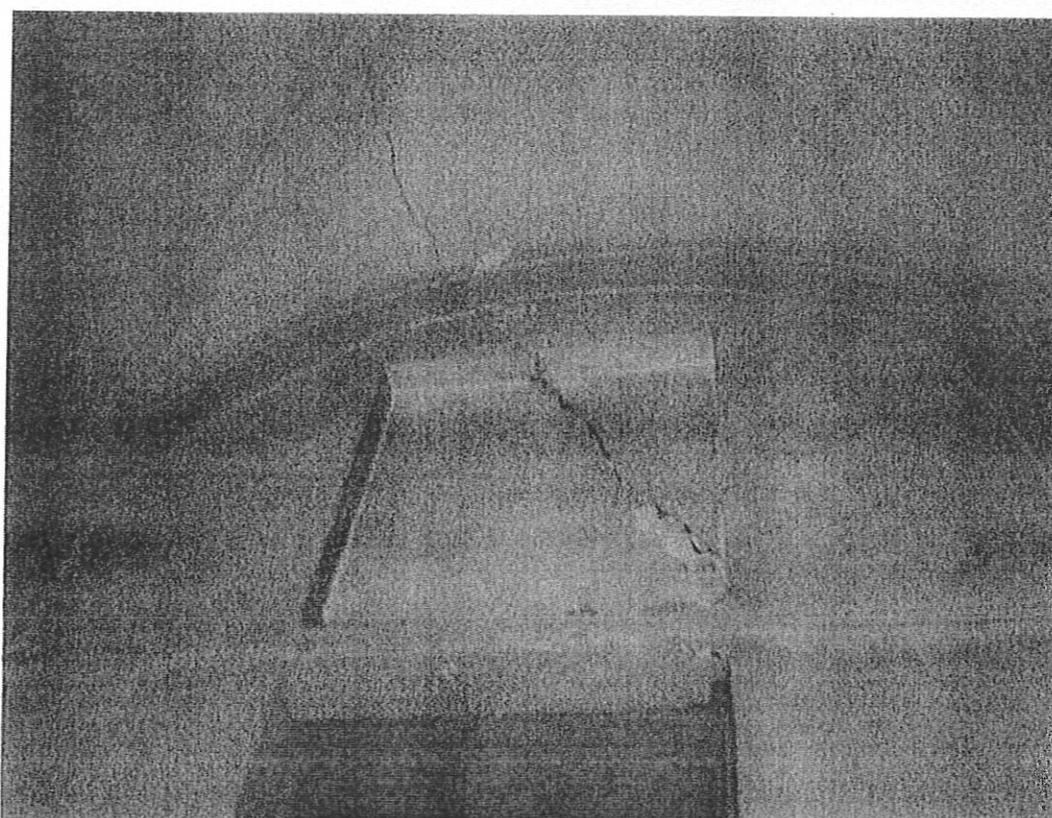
Fessura sul muro di spina della manica su V. Lobetto (21.06.2016)
